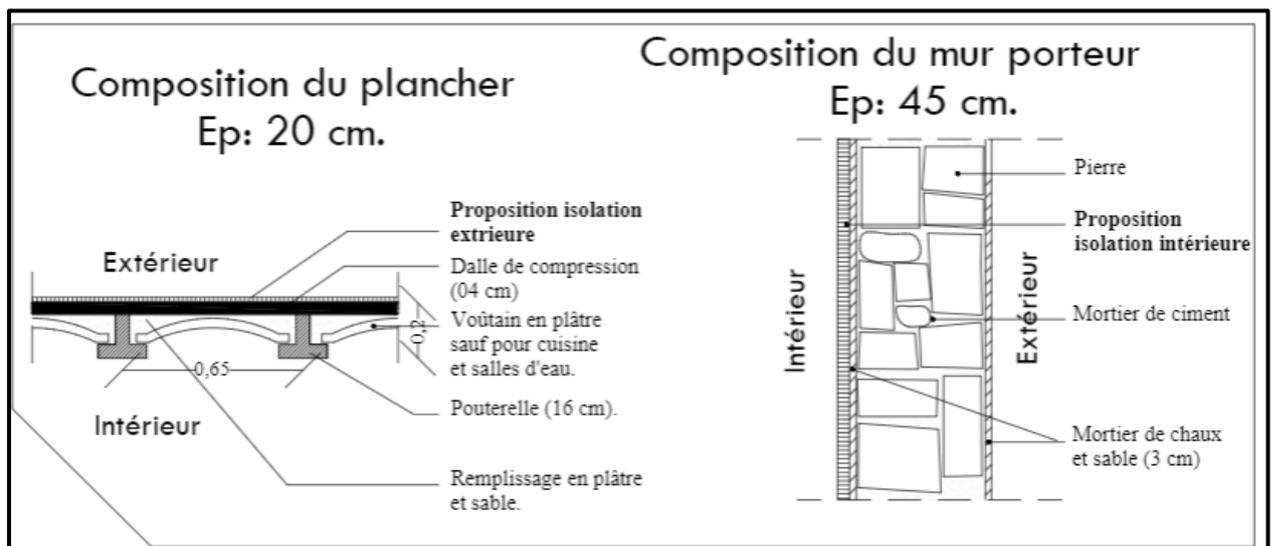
Schéma explicatif de la composition du plancher et du mur porteur
